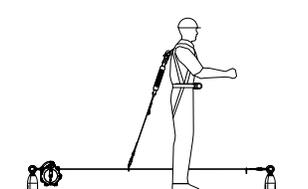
Ancrage de toiture - Toitures en métal, béton et contre-plaqué
